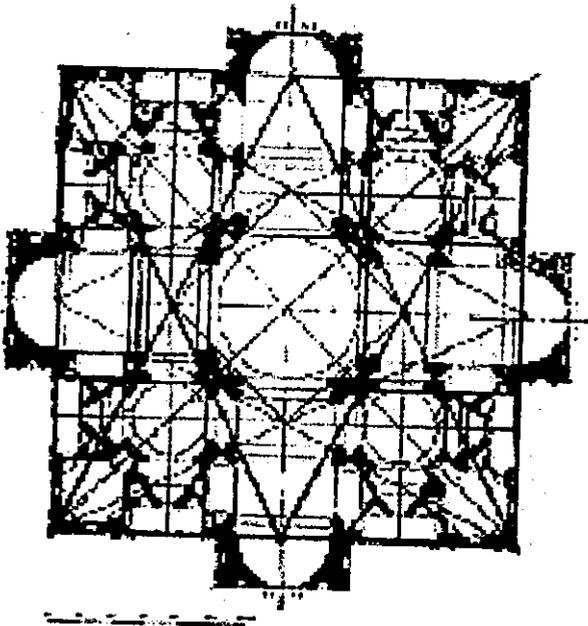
Trazo de la planta original de San Pedro, proyecto de Bramante.
